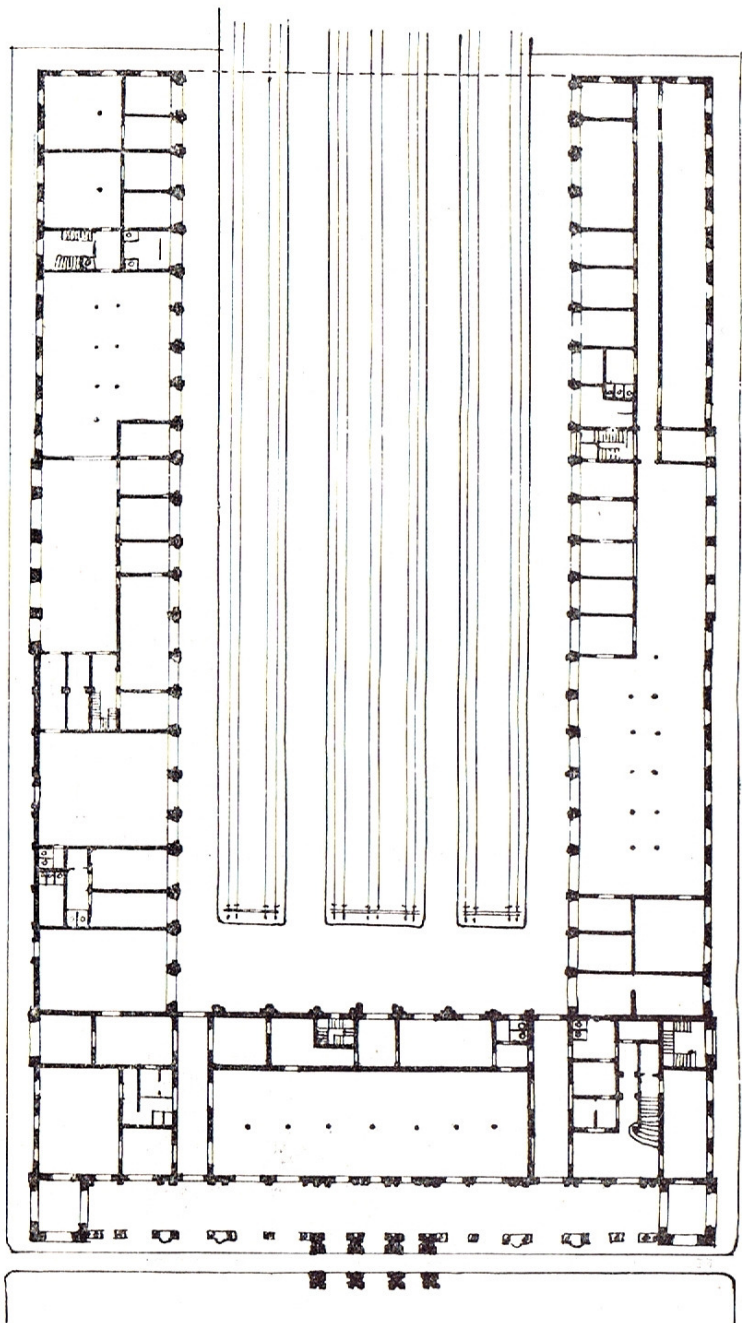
Estación del Ferrocarril Central — Planta baja.
